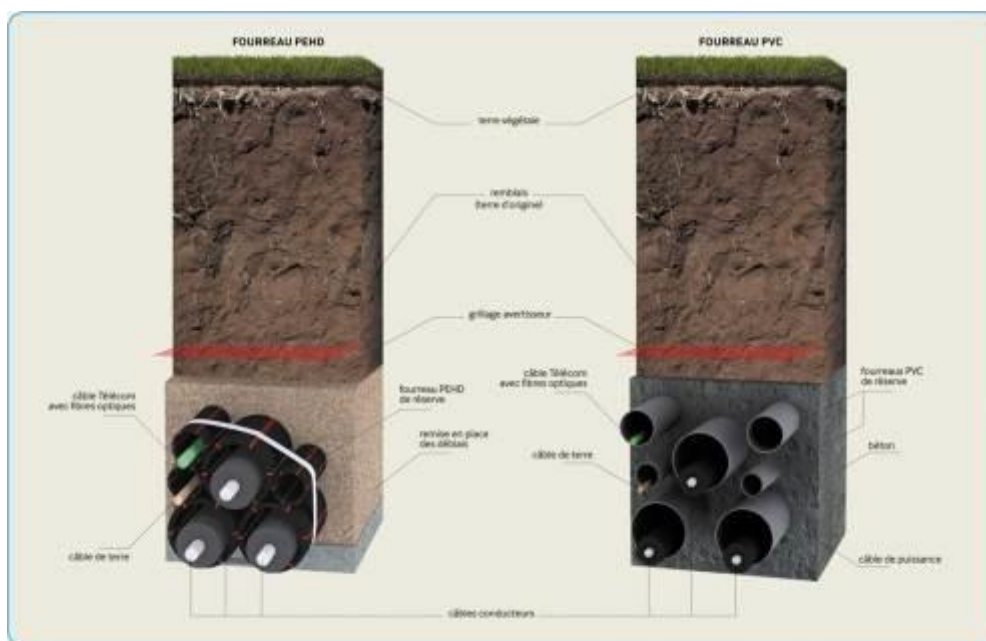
Schéma de pose en fourreau PEHD (©RTE) (gauche) et en fourreaux PVC (©RTE) (droite)
